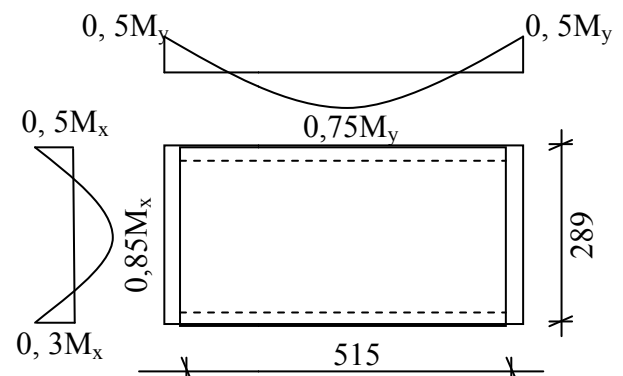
Panneau de dalle appuie sur 4 coté.
